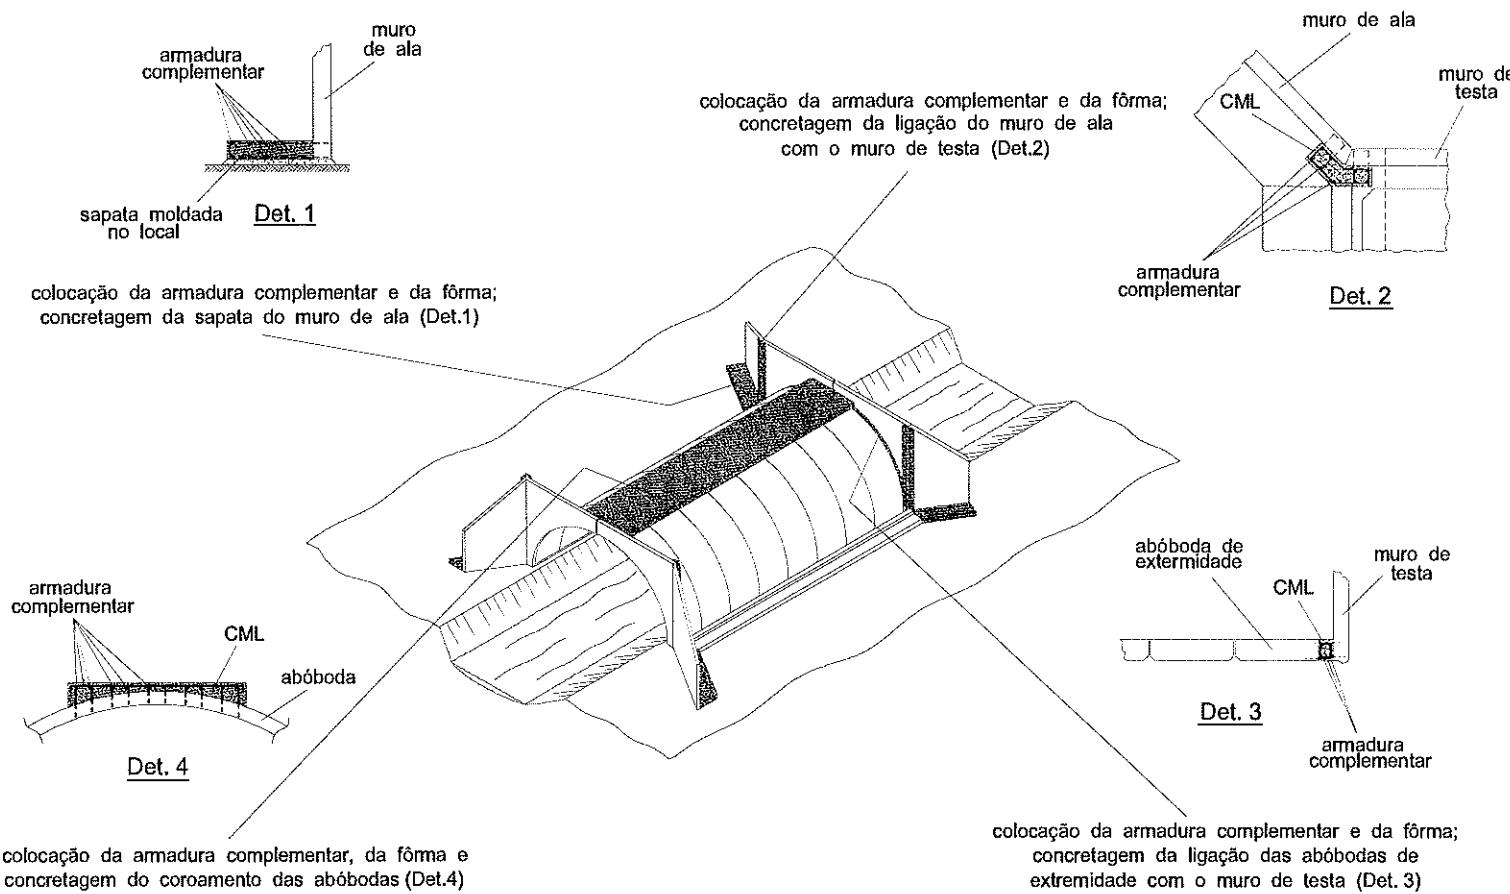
Colocação da armadura complementar e das fôrmas; moldagem das partes de concreto moldado no local (término da estrutura)
